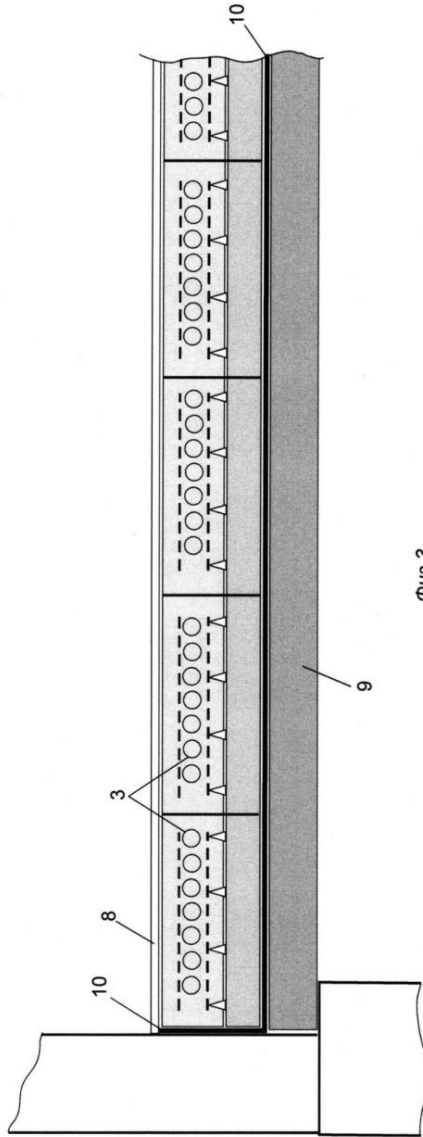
Фрагмент сечения здания с теплым полом в разрезе [3], где: 3 – тепловой элемент, 8 – пол помещения, 9 – основание, 10 – гидроизоляционный теплоотражающий слой
